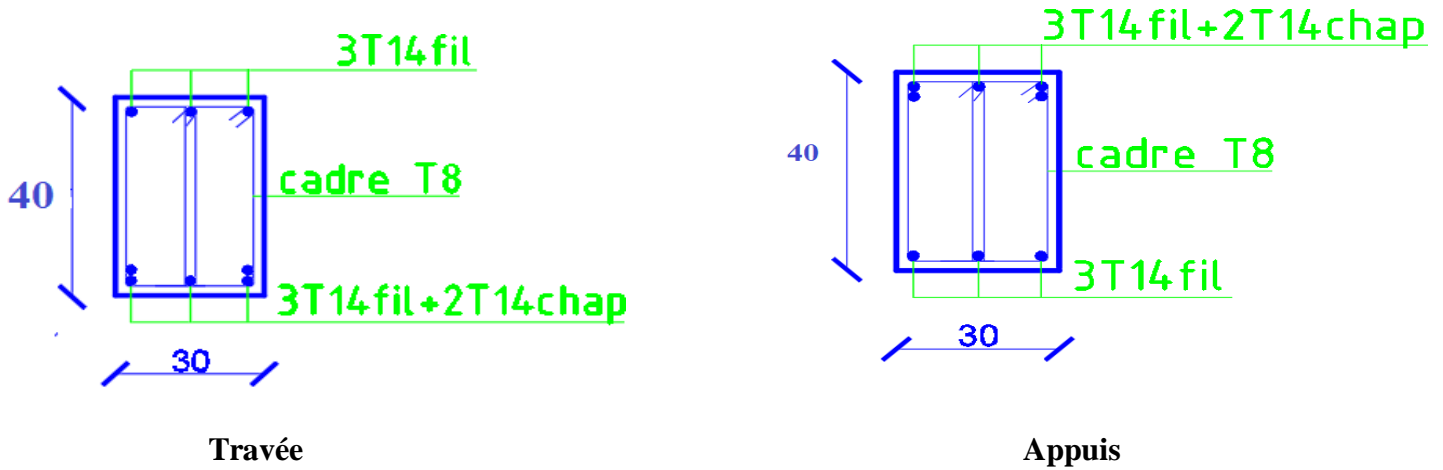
Schéma de Ferrailage de Poutre 40x30 cm .
